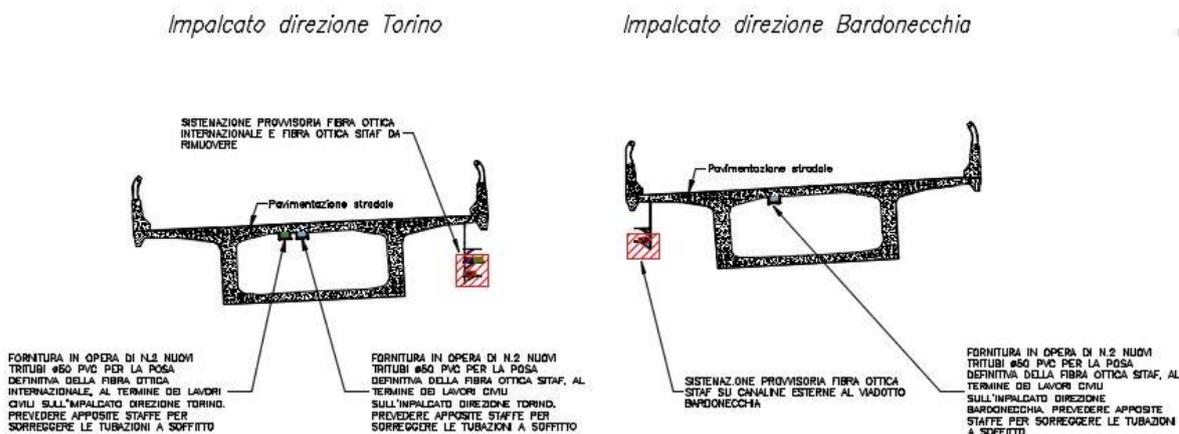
Viadotto Clarea – Posizione fibre ottiche SITAF FASE 2
